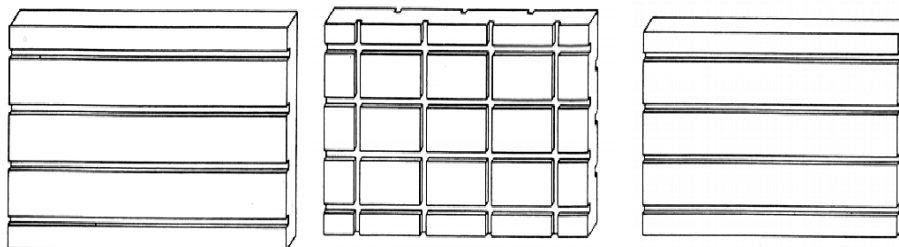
Ranhuras nas faces das placas de isolante [33]
